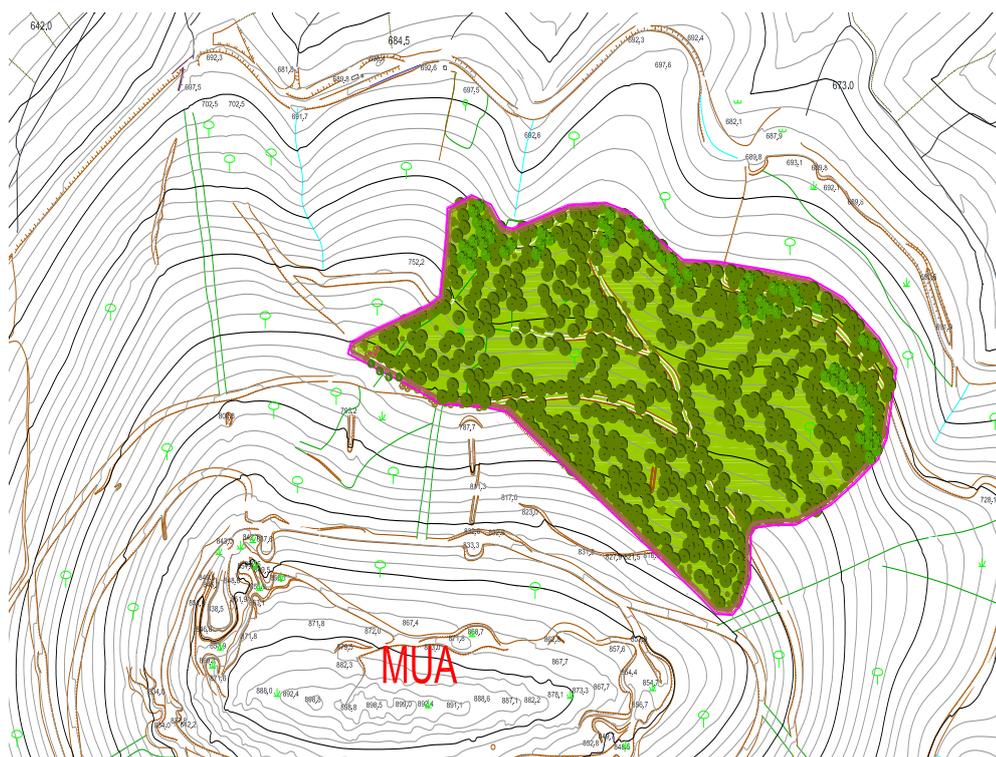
Planta esquemática da recuperação paisagística na área de escavação da Mua (casalheiras).
